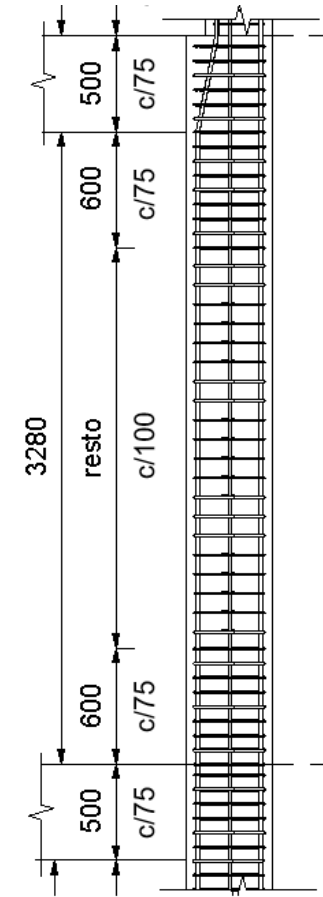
Corte longitudinal de la columna. [Elaboración propia]
